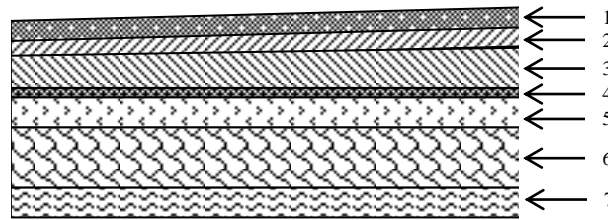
Coupe transversale du plancher terrasse inaccessible
